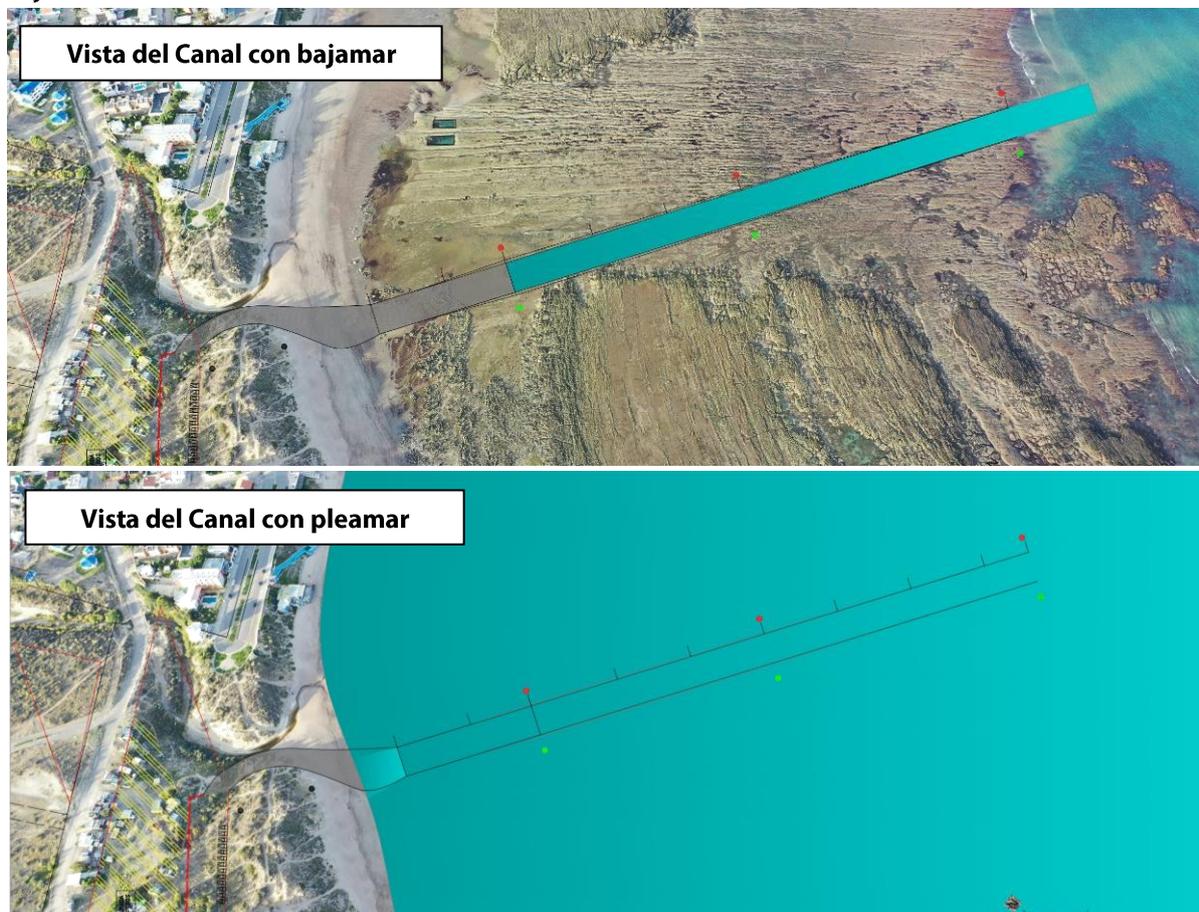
Croquis de proyecto con pleamar y bajamar. Fuente: elaboración propia
